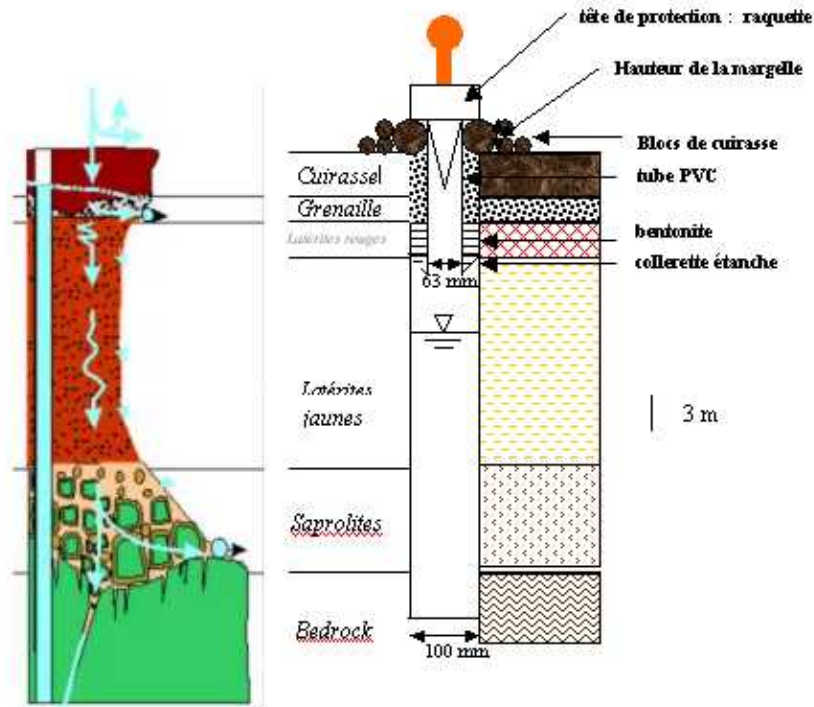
Schéma d'installation d'un ouvrage temporaire
